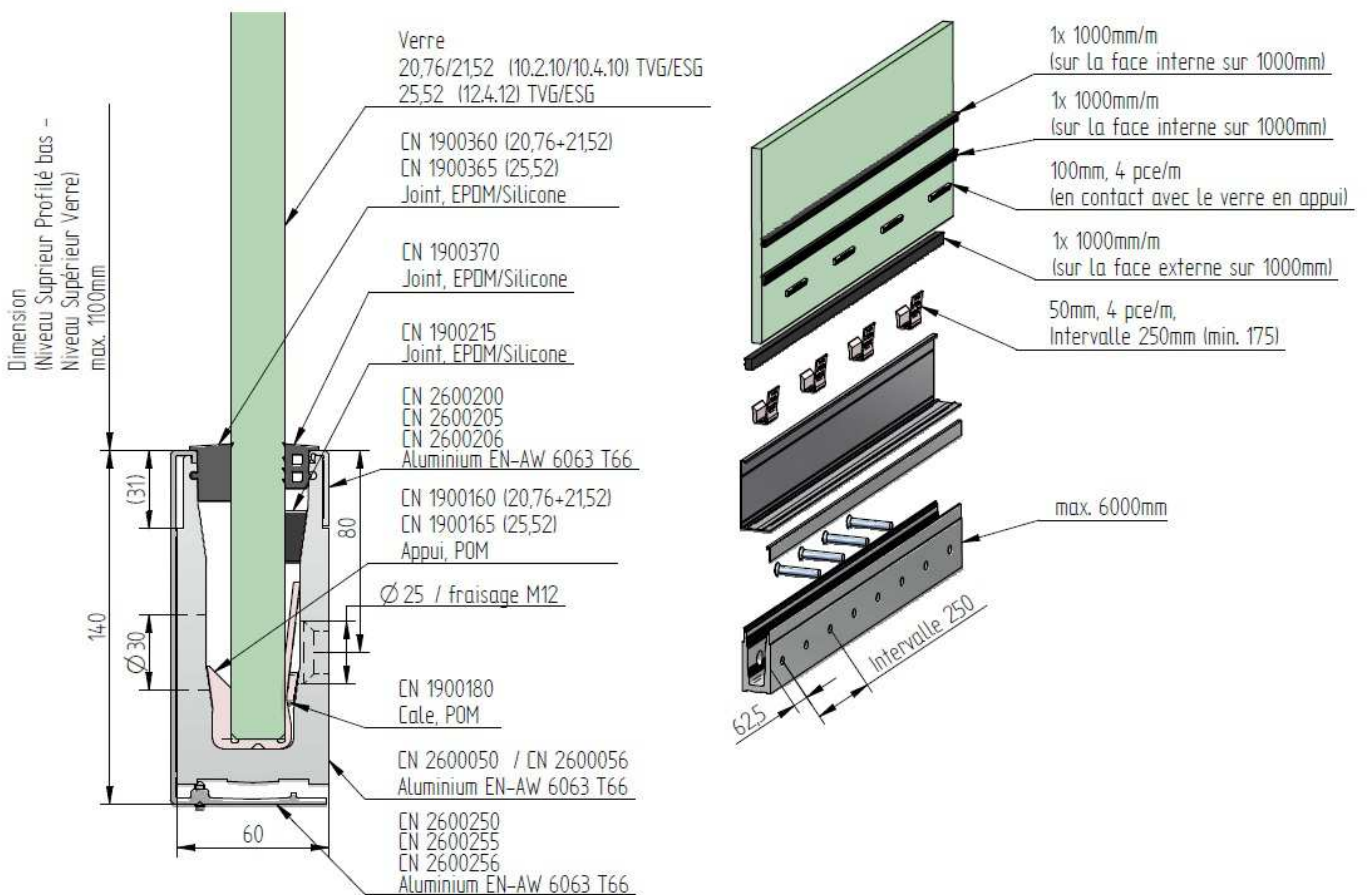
CROSLUX 2.0 – Montage en nez de dalle
